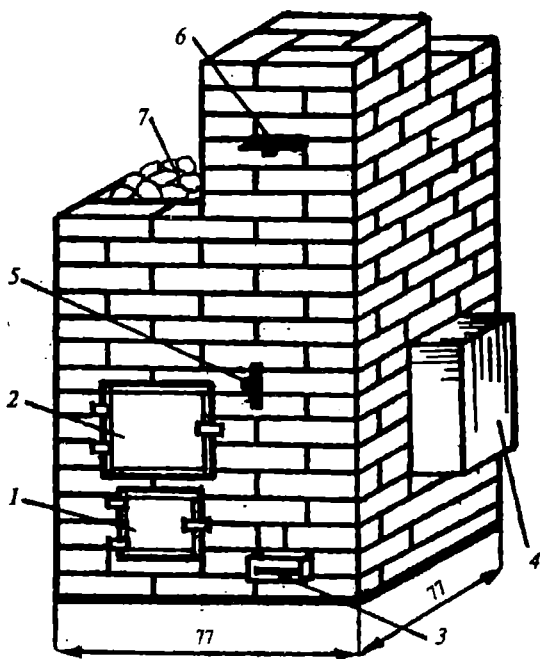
Печь-каменка с нижним размещением бака (размеры в см): 1 — дверка поддувальная; 2 — дверка топливника; 3 — нижняя заслонка; 4 — бак; 5 — верхняя заслонка; 6 — чистка; 7 — плита с камнями
